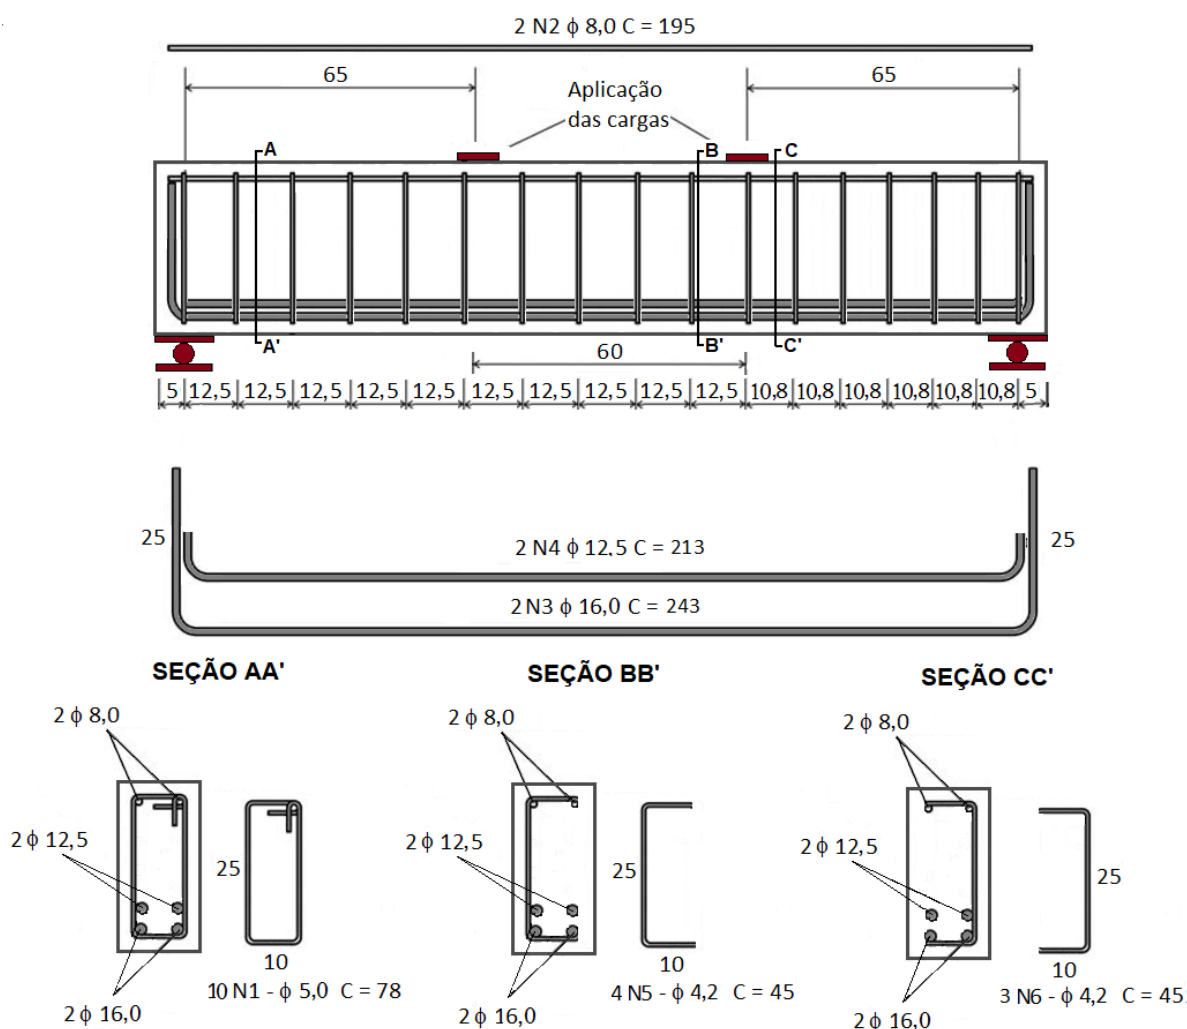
Armaduras das vigas do Tipo 4 (dimensões em centímetros, exceto diâmetros que estão em milímetros).
